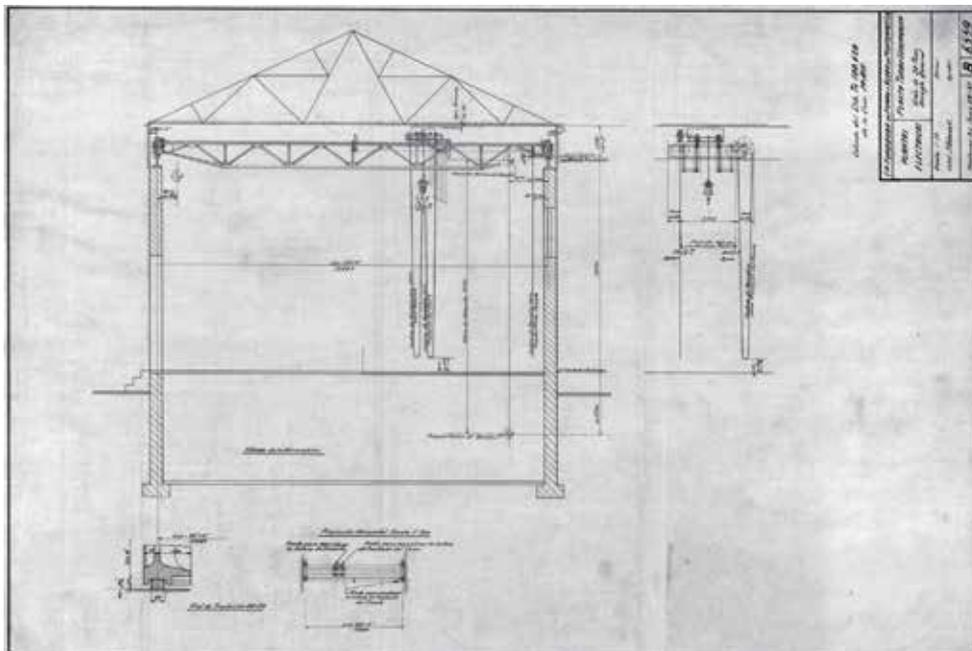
Plano B-6559 "Planta Eléctrica. Grúa de 20 Tons". Archivo Histórico Fundidora, 28 de junio de 1937. AHF.
